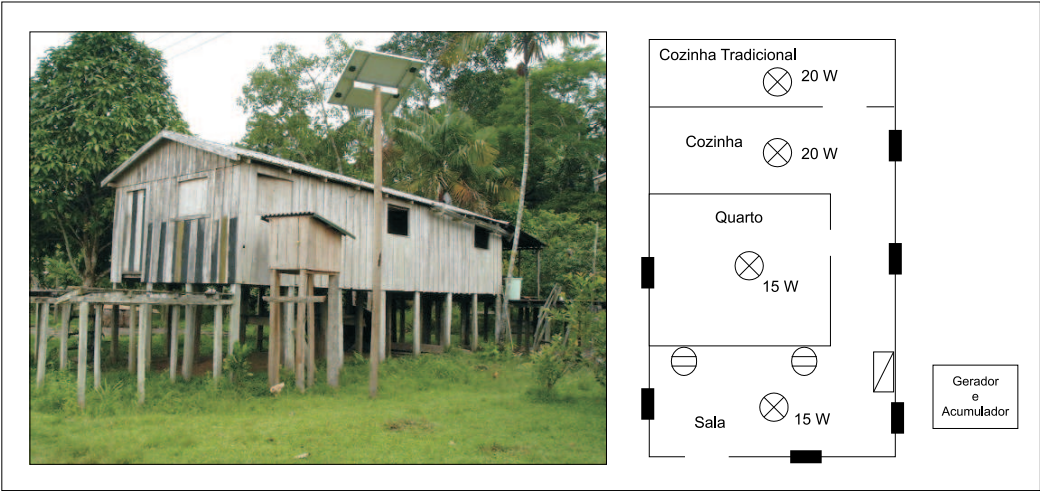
Vista externa do SFD4 e planta aproximada do domicílio.
